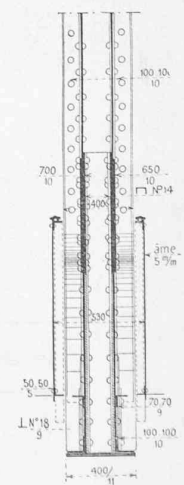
Colonne sur escalier. — Coupe en long au milieu.
